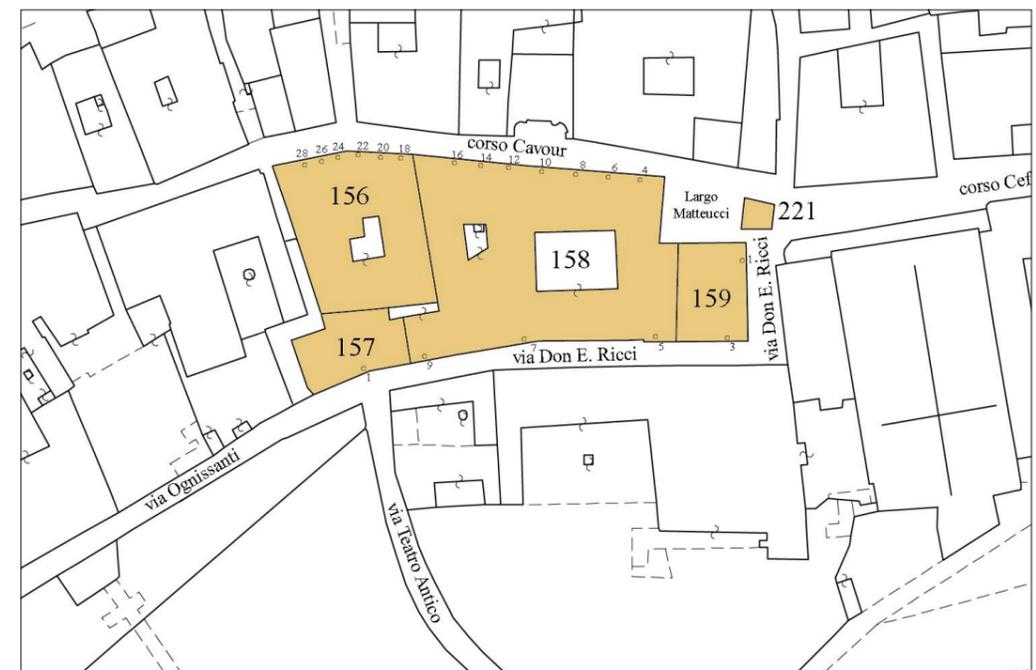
Planimetrica catastale con individuazione degli edifici dell'isolato di studio.
